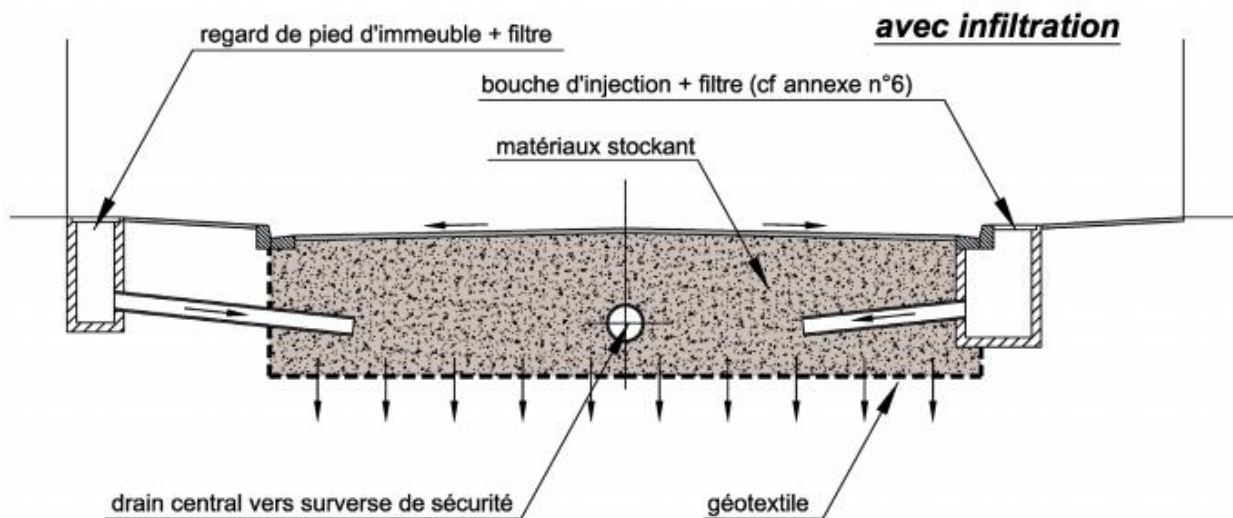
Exemple de chaussée réservoir (Source : CETE Nord - Picardie)
